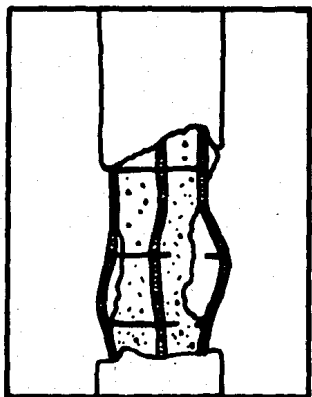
(3) Falla de Columna por compresión excéntrica
